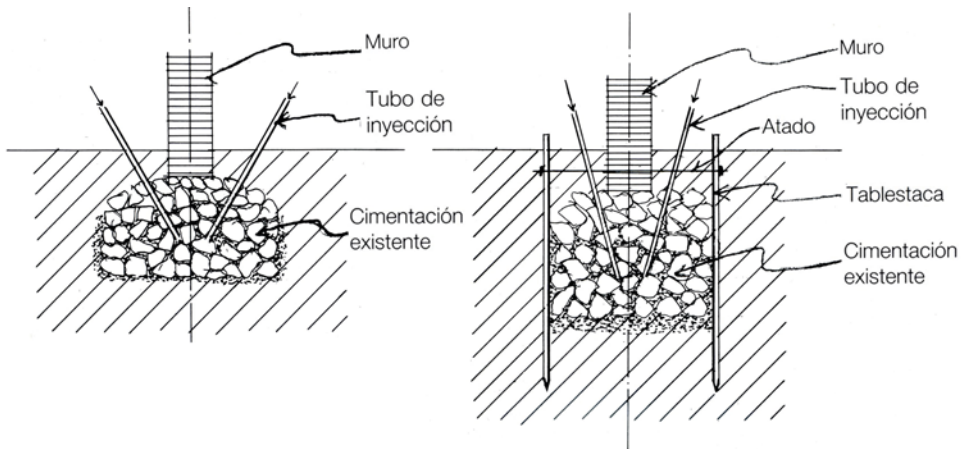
Inyecciones a base de lechada de cemento en cimentación de mampostería con conglomerante degradado o inexistente. En la foto derecha, se confinan los límites de la zapata con tablestacado.
